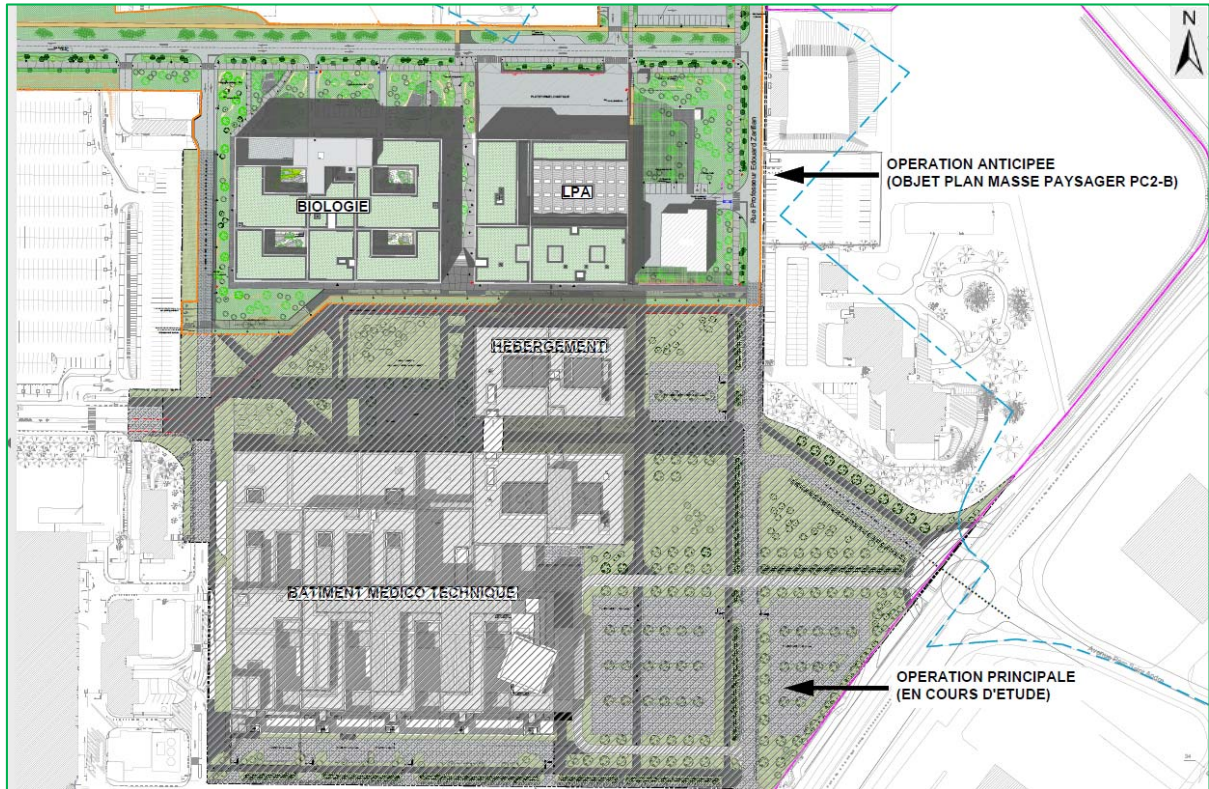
Extrait du plan de masse projet (source plan AIA : « PC02-a_AI_Plan masse paysager »)
